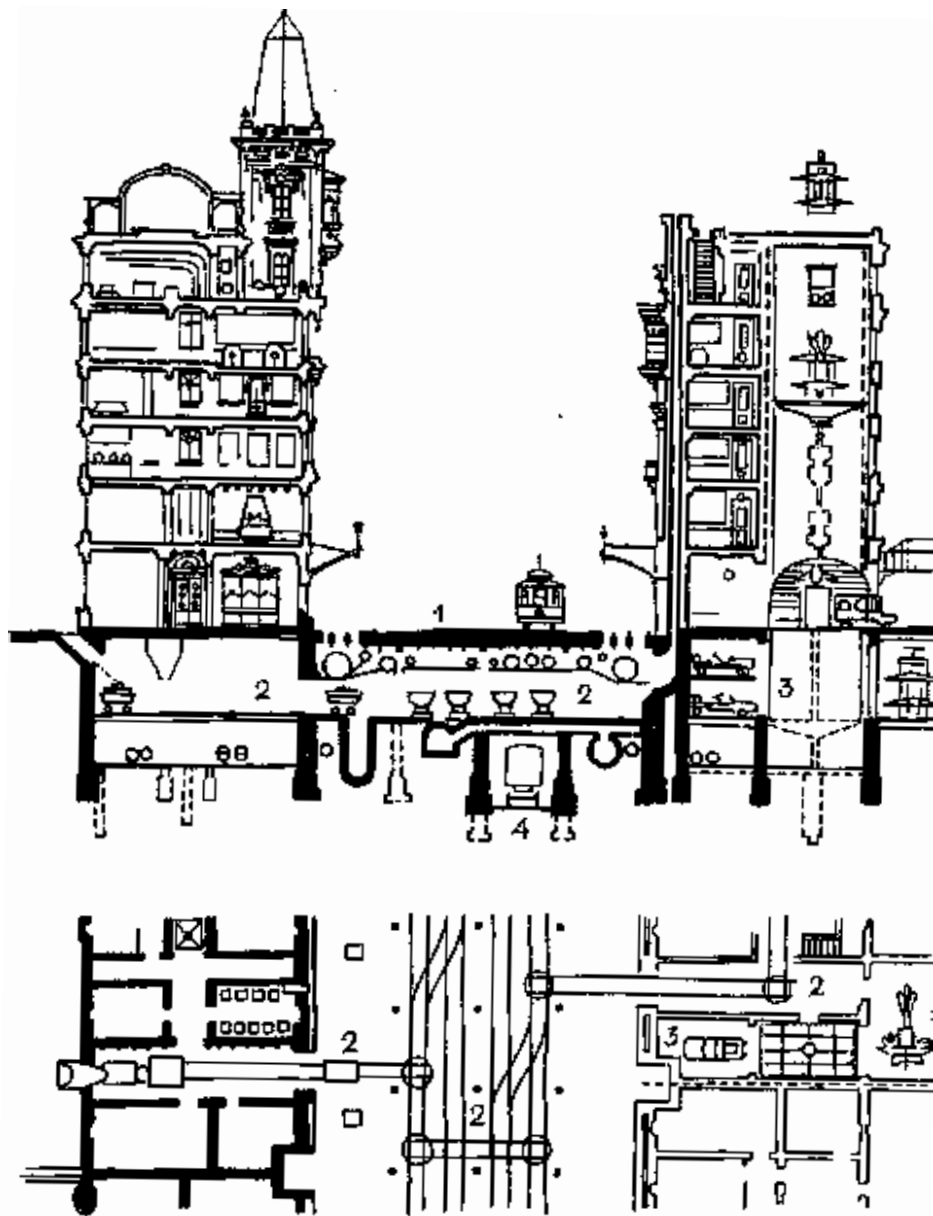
«Улицы будущего» Эжена Энара (Франция, 1910 г.). Разрез и фрагмент плана:
